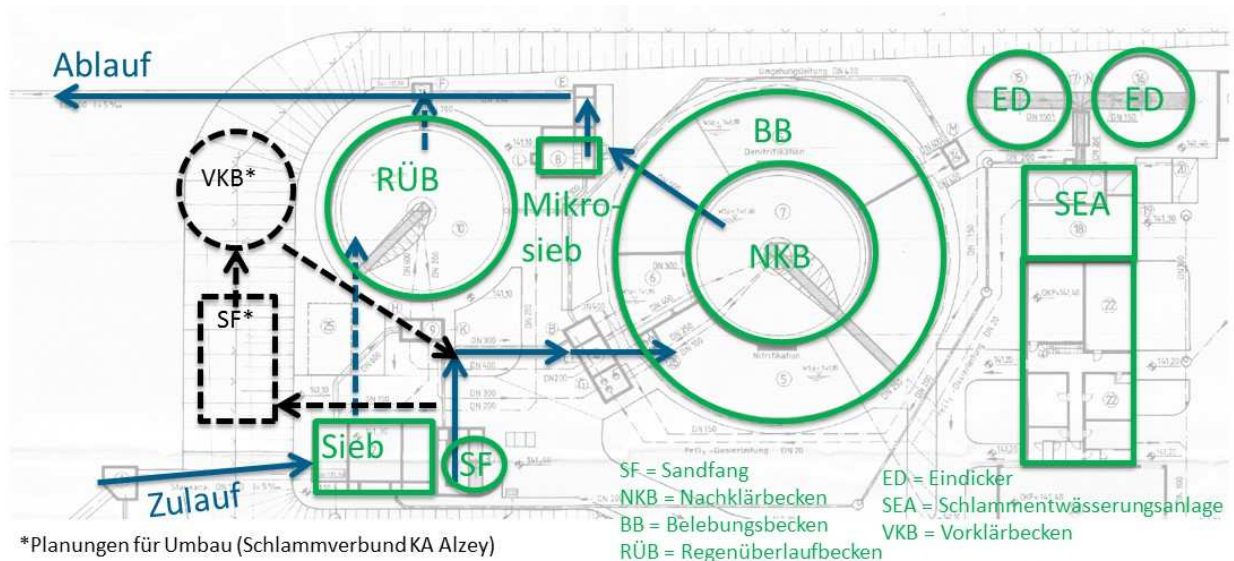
Lageplanschema der Kläranlage Flonheim mit Skizzierung des Wasserwegs
